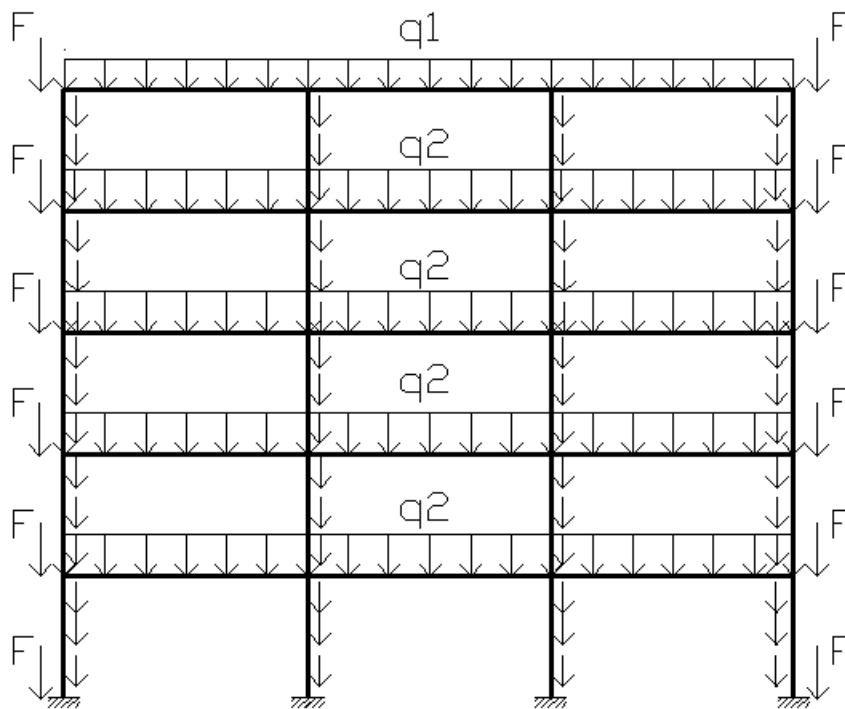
Расчетная схема рамы при действии вертикальных статических нагрузок (от веса собственного веса конструкции и временной нагрузки на перекрытия)
